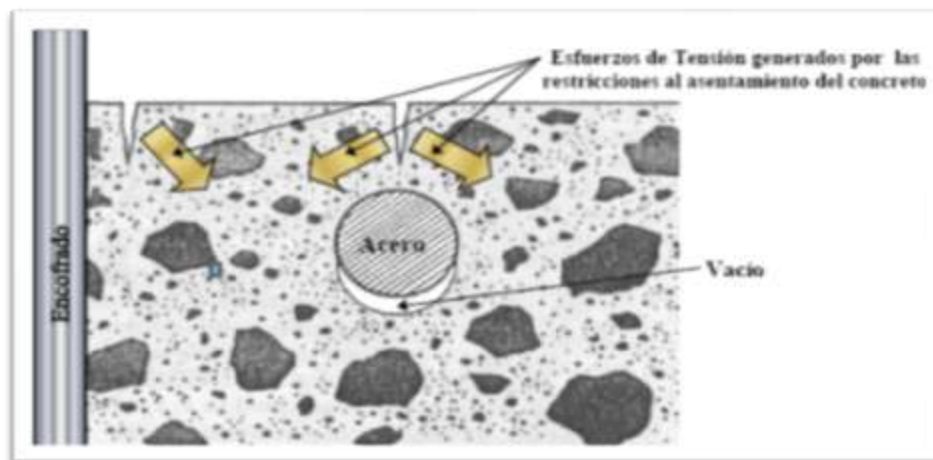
Grietas por asentamiento plástico.
